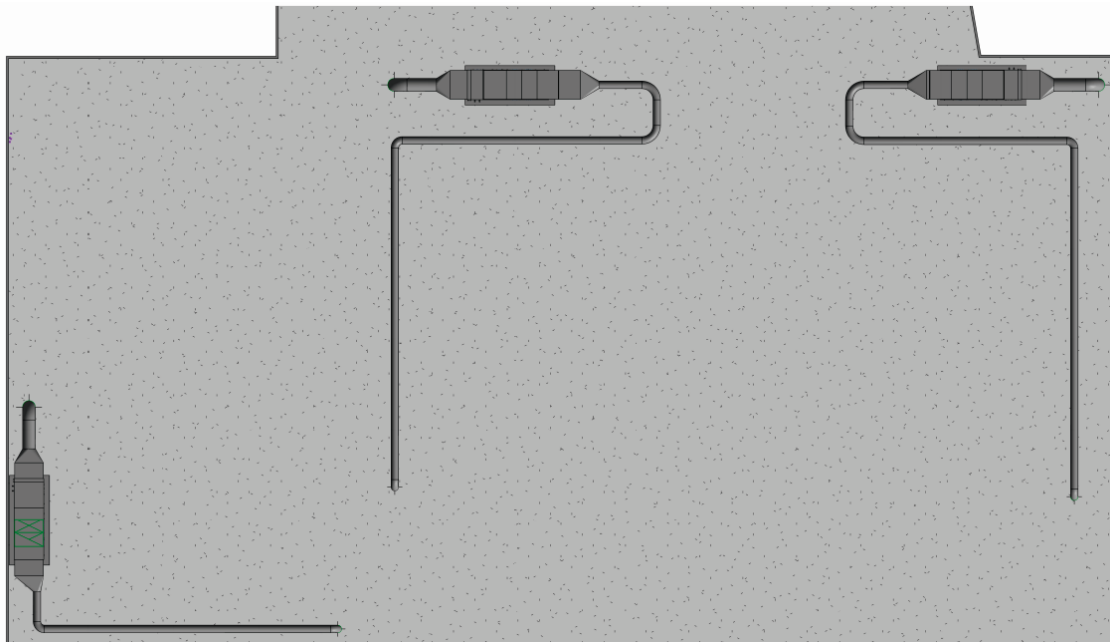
Planta do terraço com condutas de insuflação e extração.
